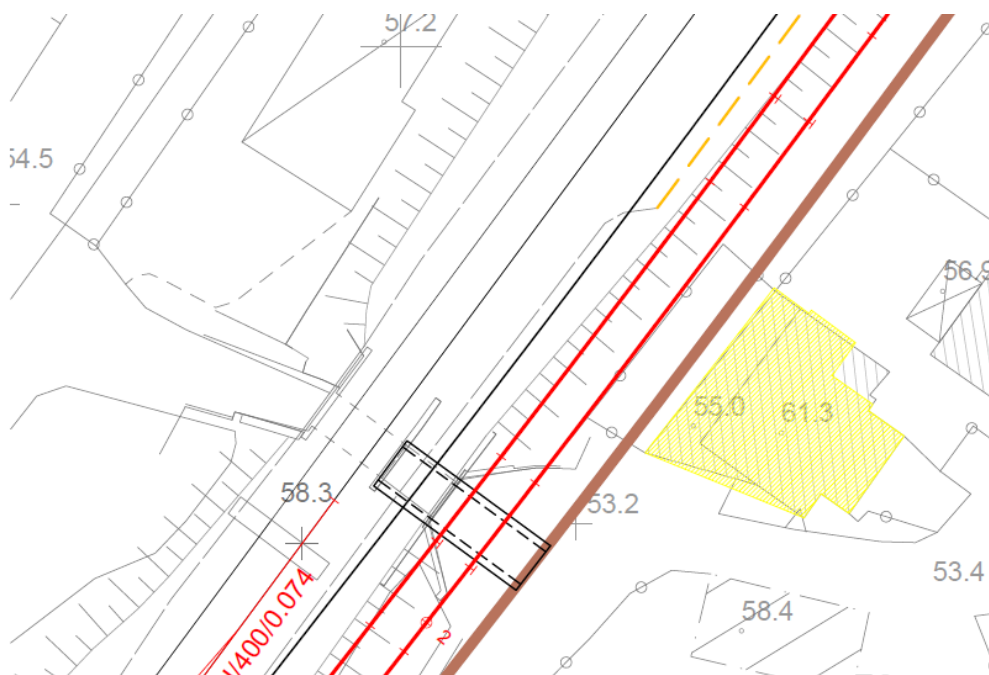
Planimetria dell'intervento del sottovia ferroviario
